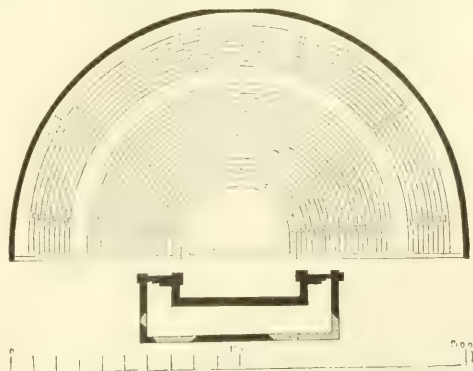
Theater zu Segesta (Grundriss).
